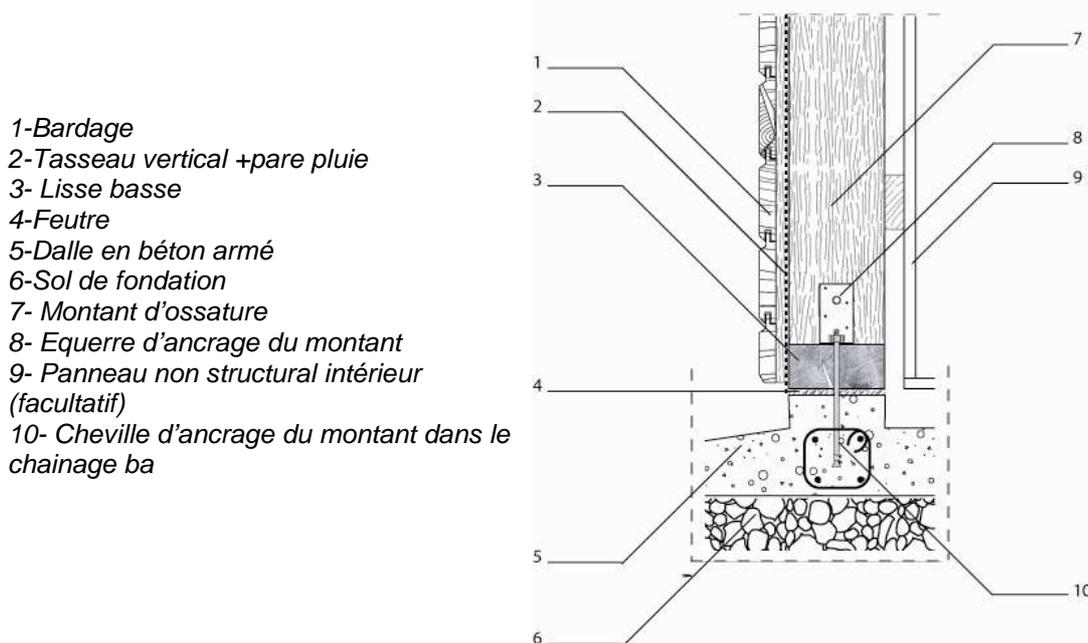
Coupe verticale sur montants d'un panneau courant secondaire.
